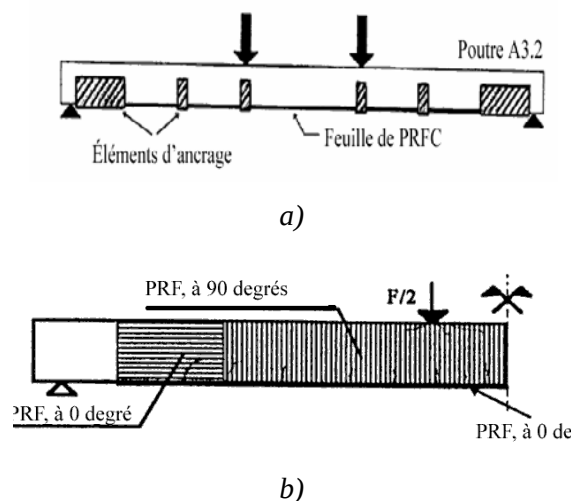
Une poutre en béton armé renforcée par une lamelle en PRF (Smith et Teng 2002)[4]
